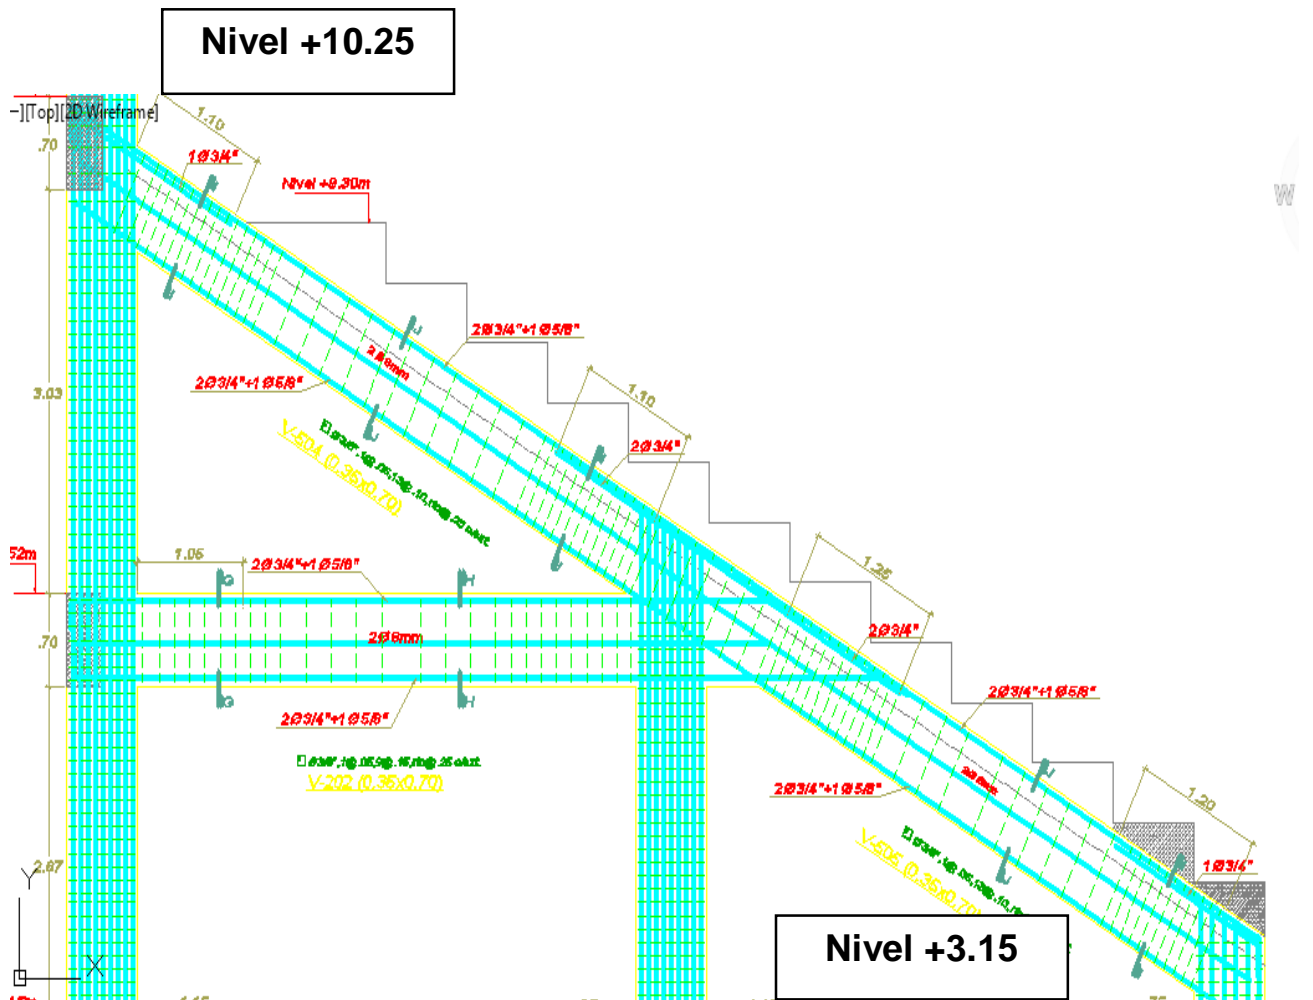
Cortado del refuerzo en vigas del eje 2
